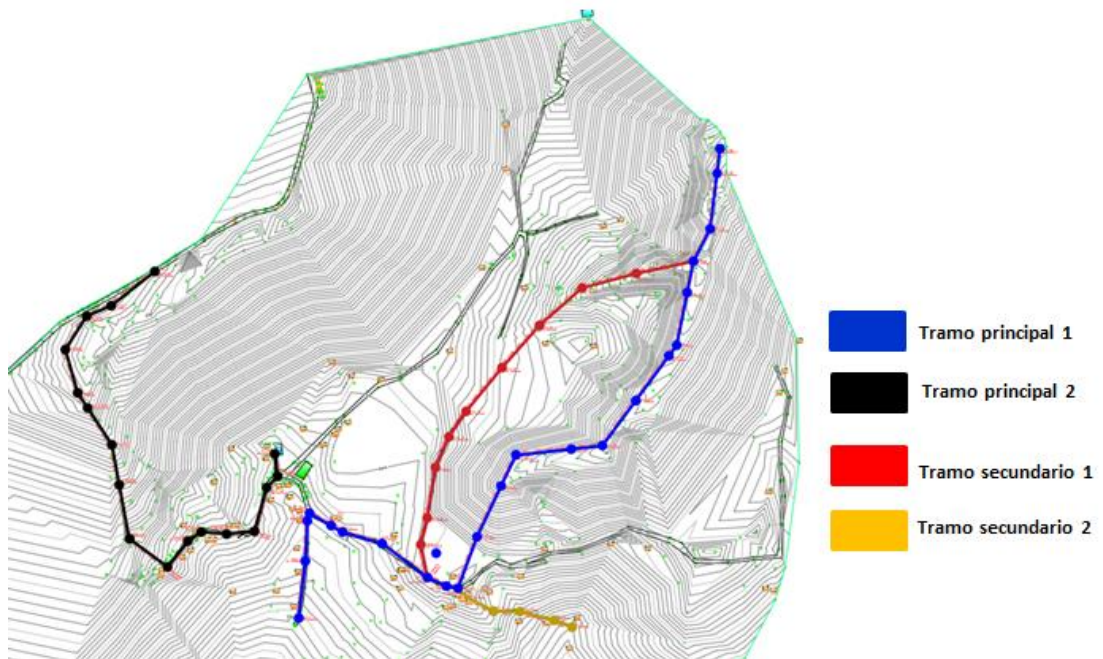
Vista en planta de la ubicación de los pozos de revisión
